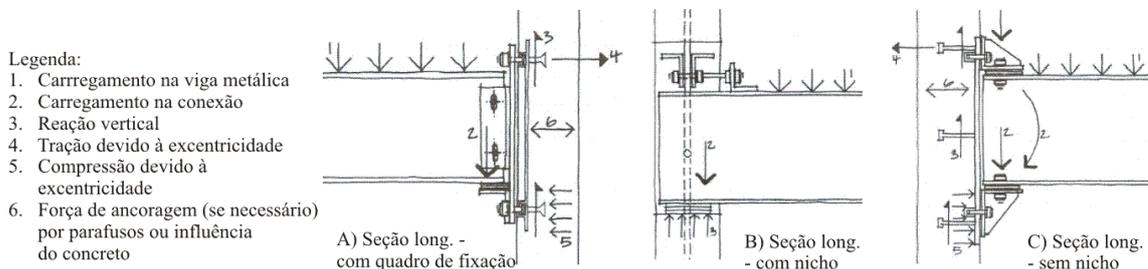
Carregamento em interfaces entre viga de aço e parede de concreto.
